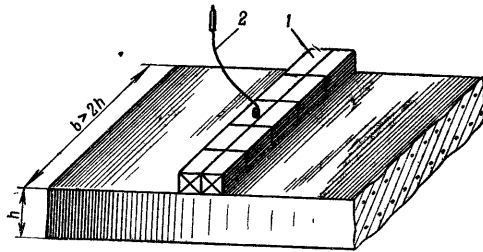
Подрывание железобетонной плиты наружным удлиненным зарядом:
